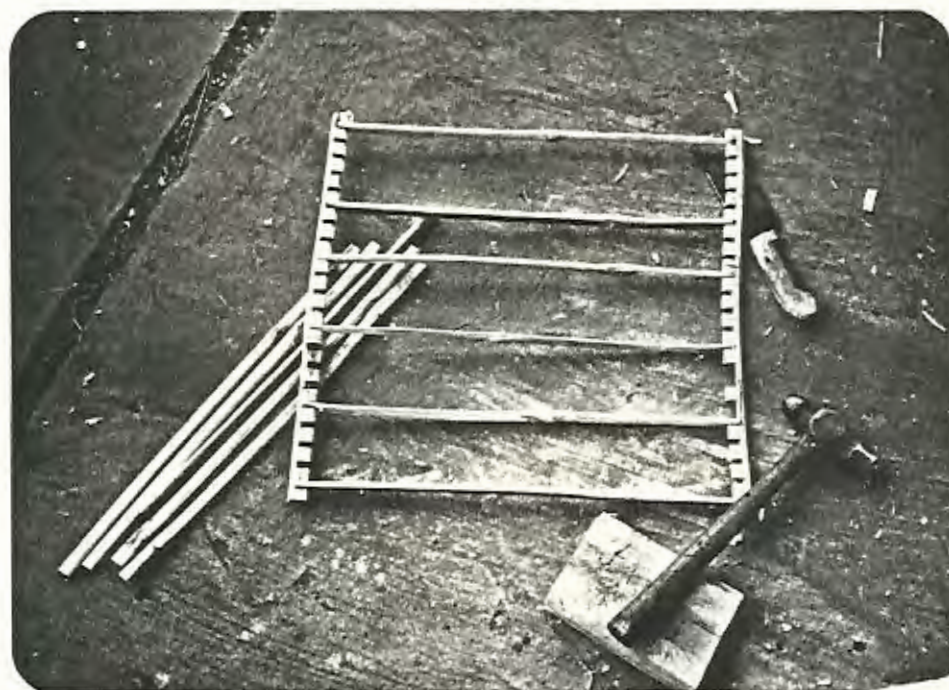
ARMADO DE LA ESTRUCTURA DE CARA
